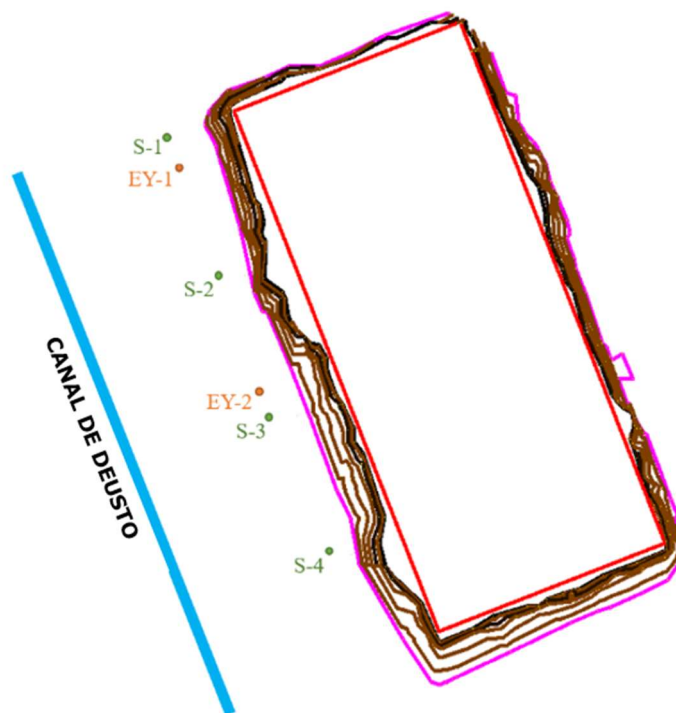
Vista en planta de los sondeos para las pruebas de inyección
